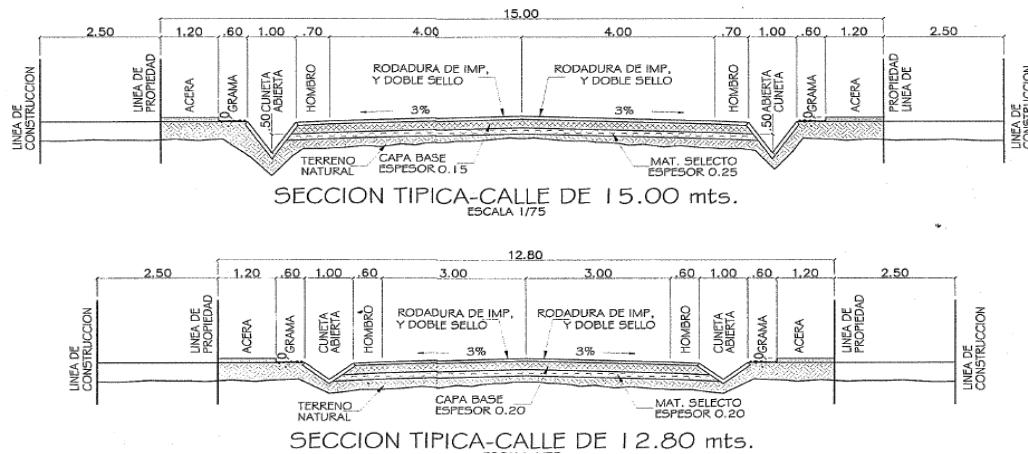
Sección típica de las calles del proyecto. Fuente: Planos de anteproyecto.
